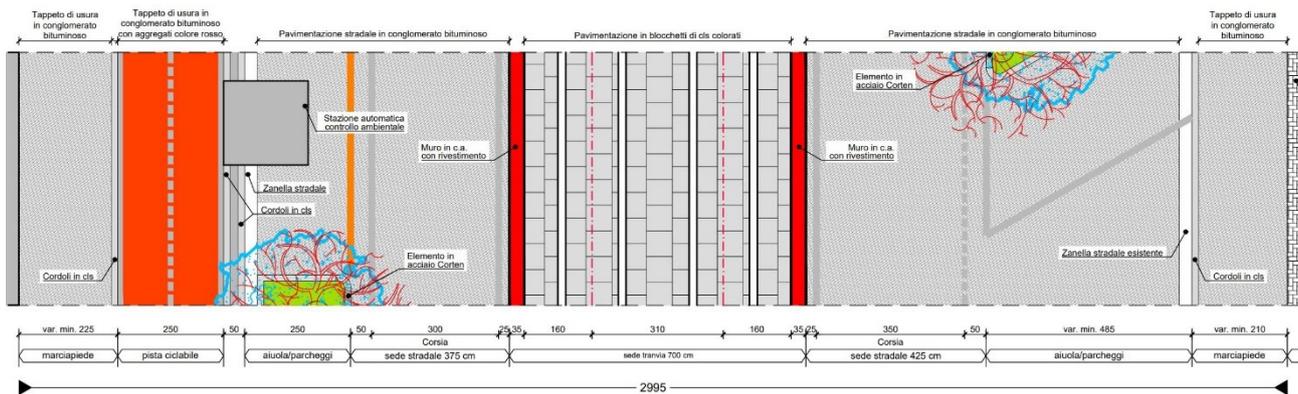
Stralcio planimetria di progetto rampa viale dei Mille
